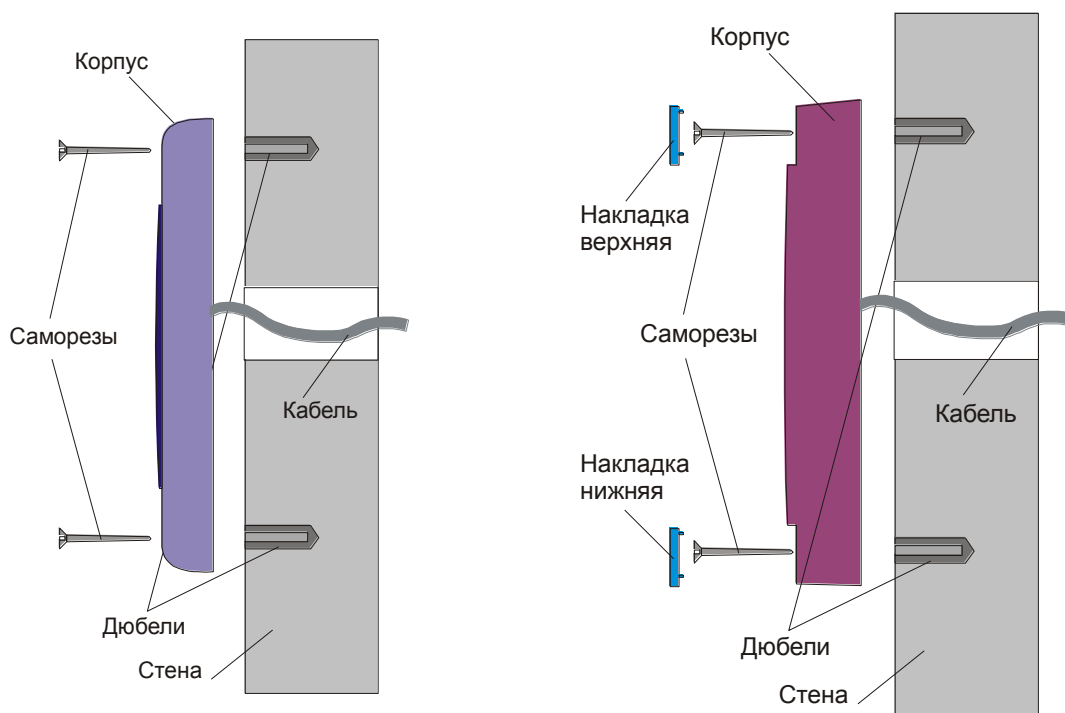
Крепление считывателя PR-P05.I. Рисунок 2. Крепление считывателя PR-P09.I.
